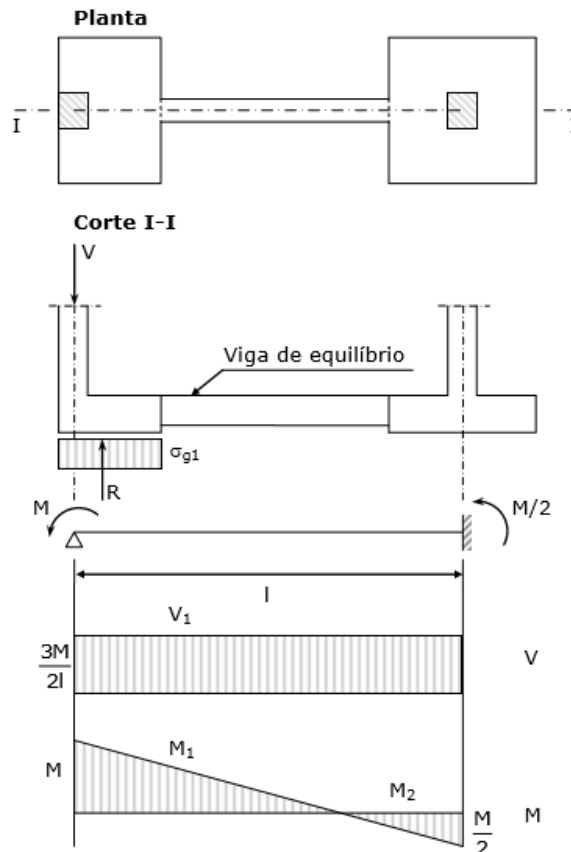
Viga de equilíbrio encastrada na sapata interior. (Félix, 2014)
